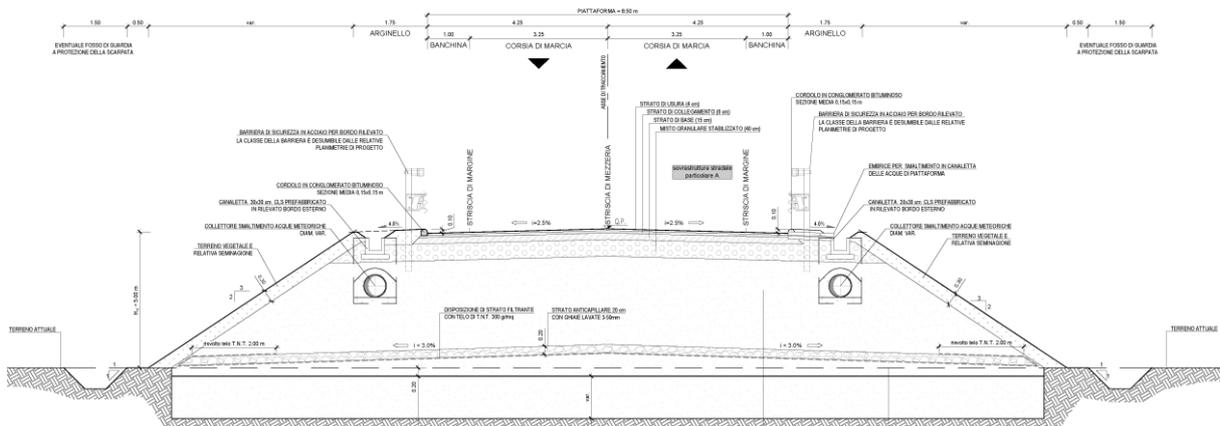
Svincolo di Baiano sezione tipo rampa bidirezionale in rilevato
